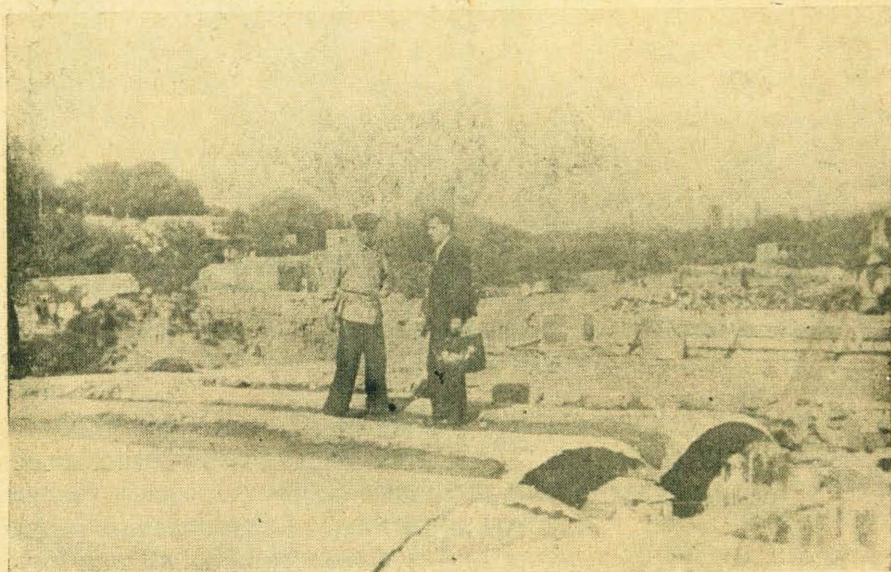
Герекрытия пол подвальным этажем перед укладкой бетона на известково-пуццолановом вяжущем.
